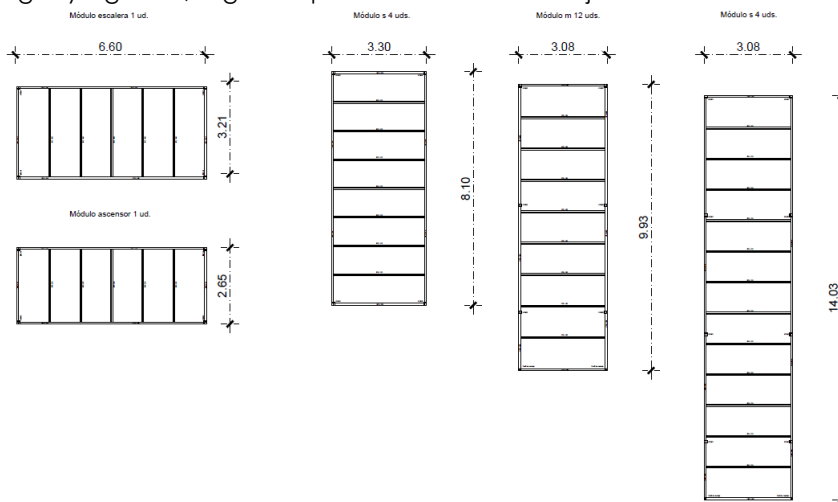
Módulos fabricados en taller (dimensiones en planta)
